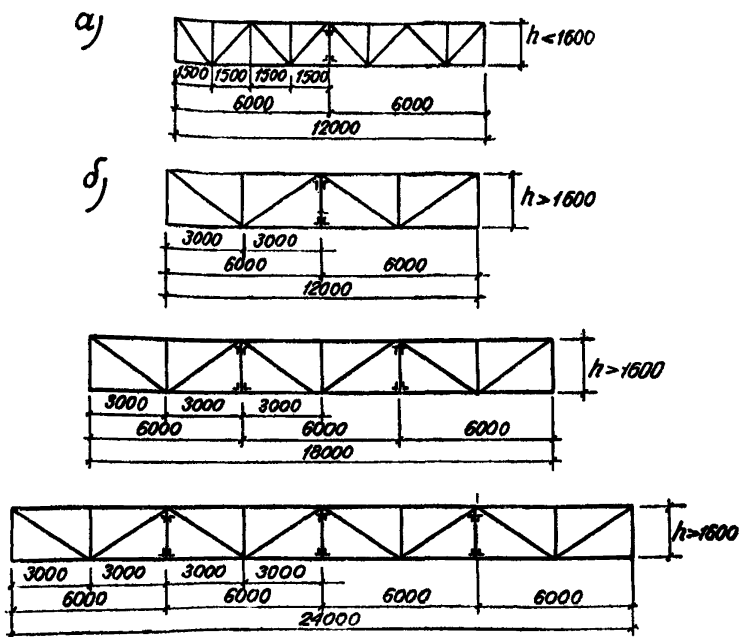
Примеры разбивки решетки подстропильных ферм в зданиях со стальным каркасом
